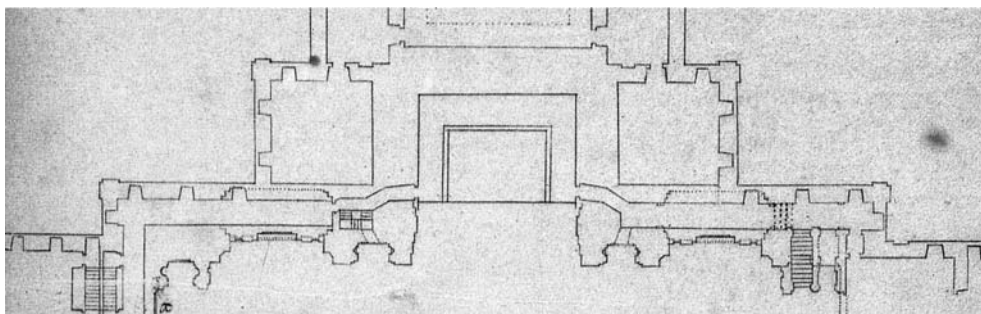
Juan Herrera, planta baja de la Iglesia, detalle de la cabecera.
